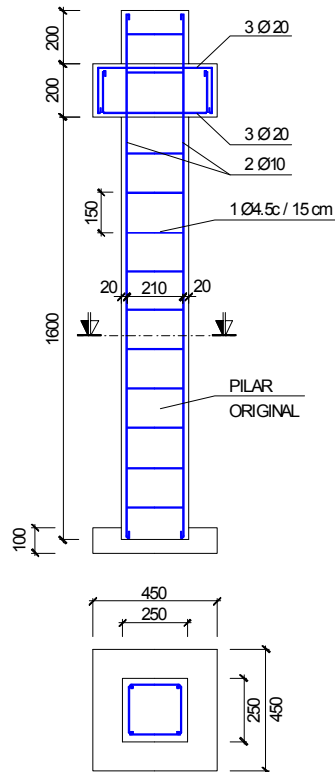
Soporte original previo al refuerzo (cotas en mm)
